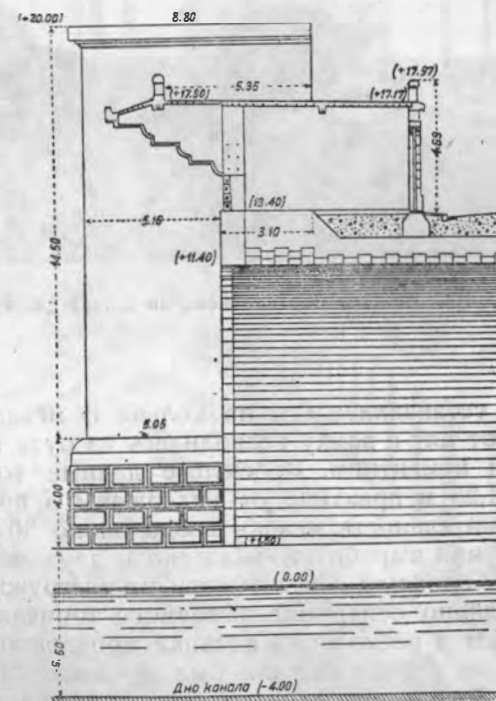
Продольный разрез по оси конструкции южного портала тоннеля.
